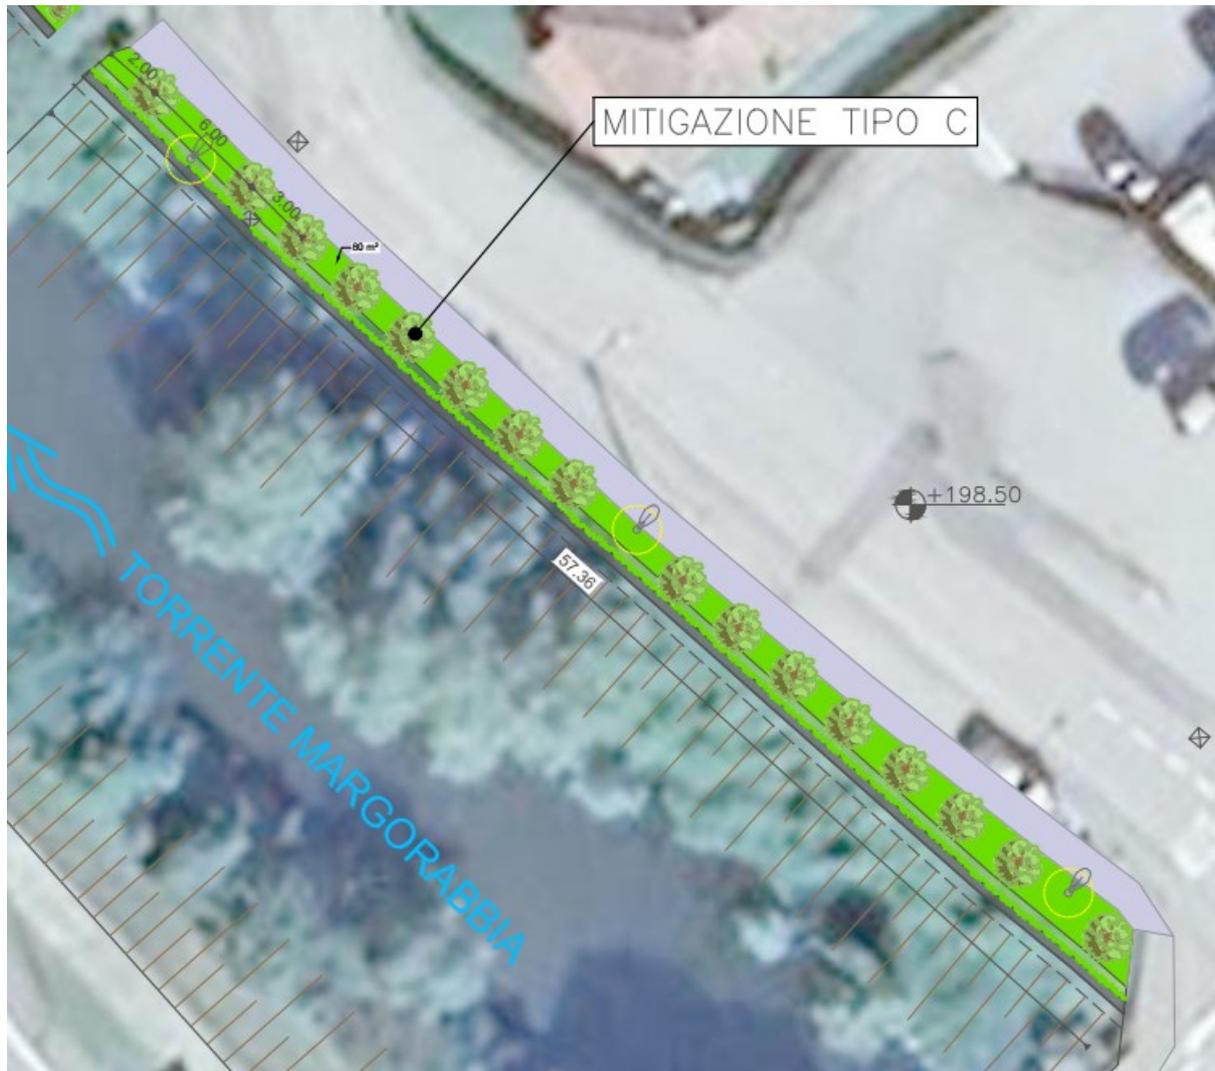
Planimetria generale mitigazioni paesaggistiche
